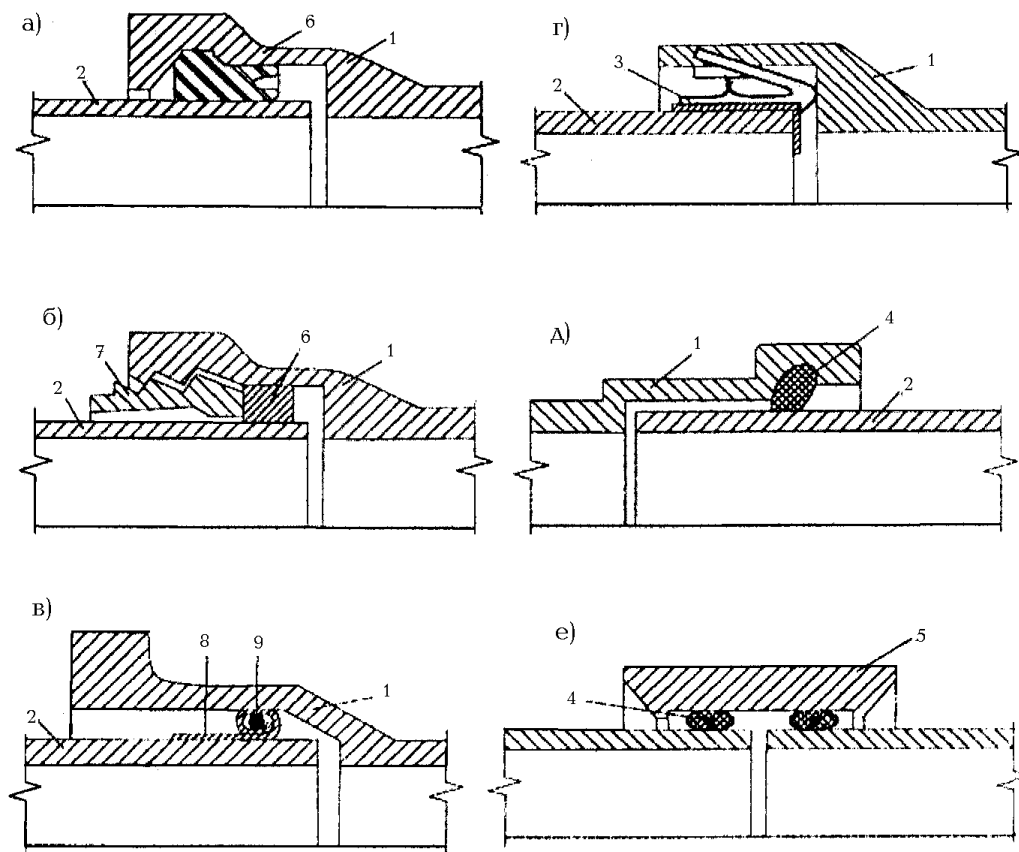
Стыковые соединения подземных трубопроводов:
